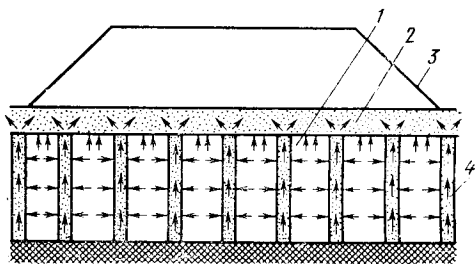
Уплотнение слабых грунтов статической нагрузкой:
